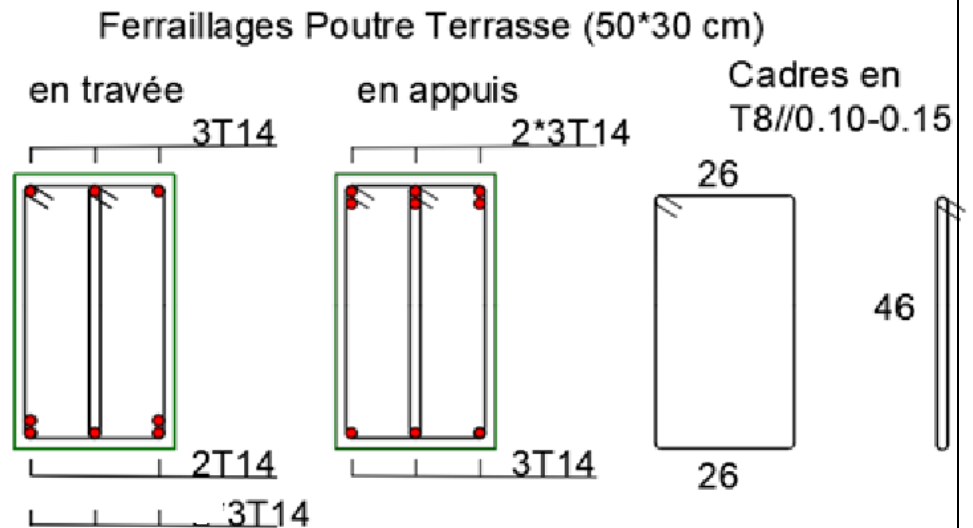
Ferraillages Poutre Terrasse 30*50 cm.
